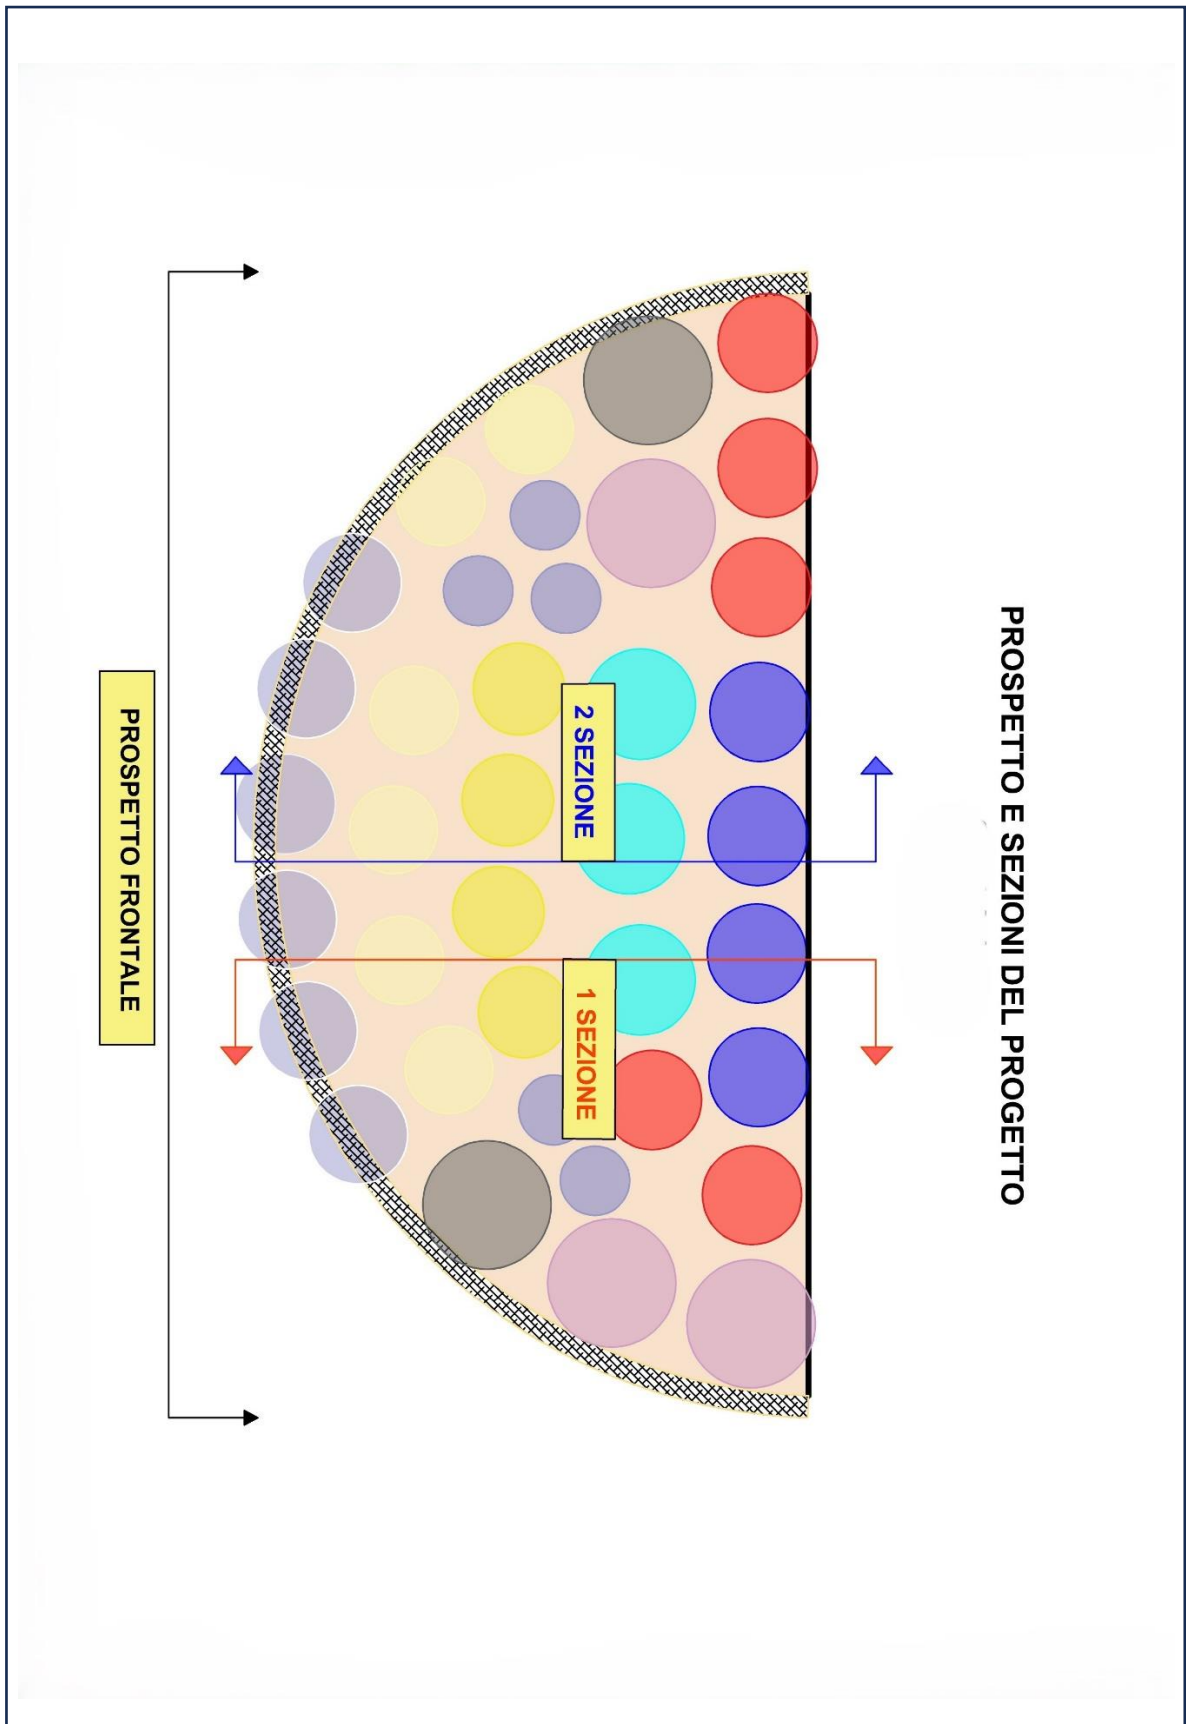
Prospetto e sezioni del progetto (AutoCad).
